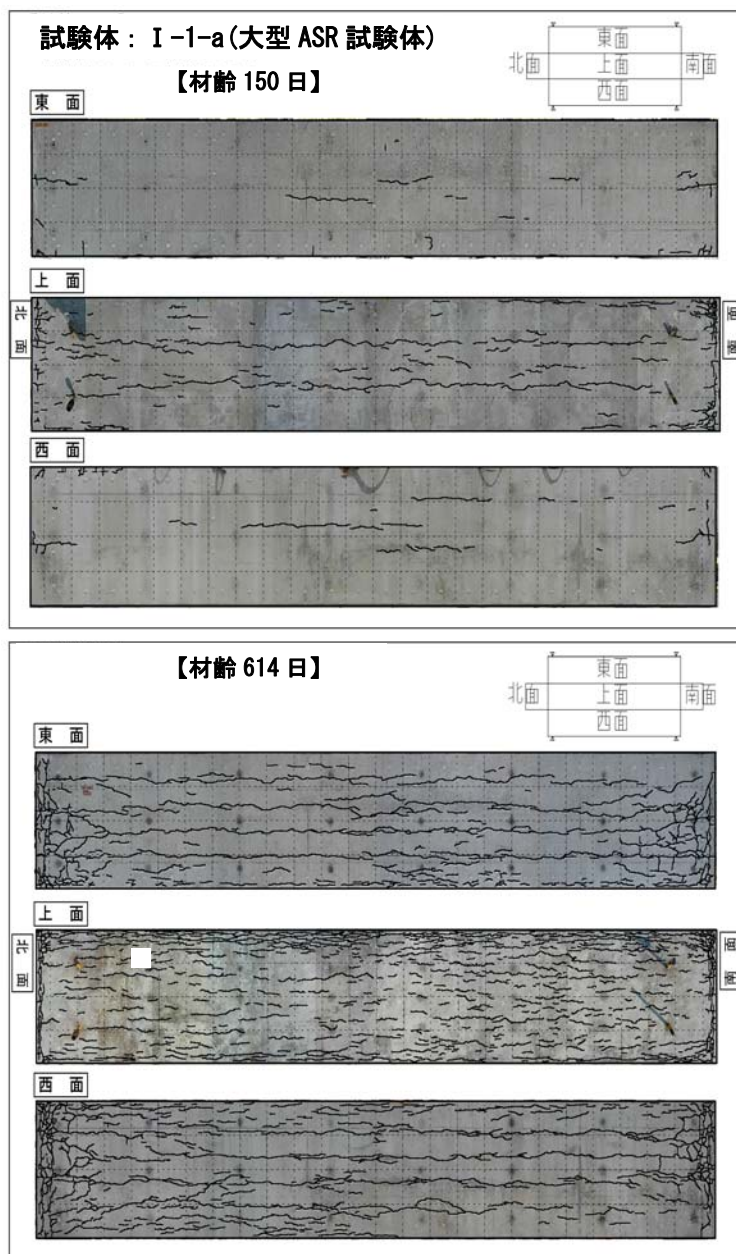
大型ASR試験体ひび割れ発生状況
